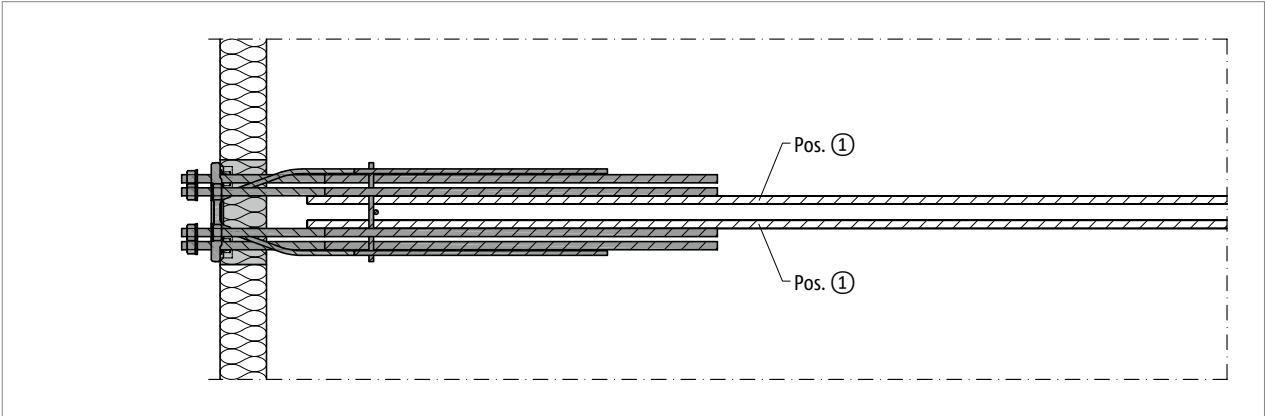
Schöck Isokorb® T Typ SKP-MM1-VV1: Bauseitige Bewehrung, Grundriss
